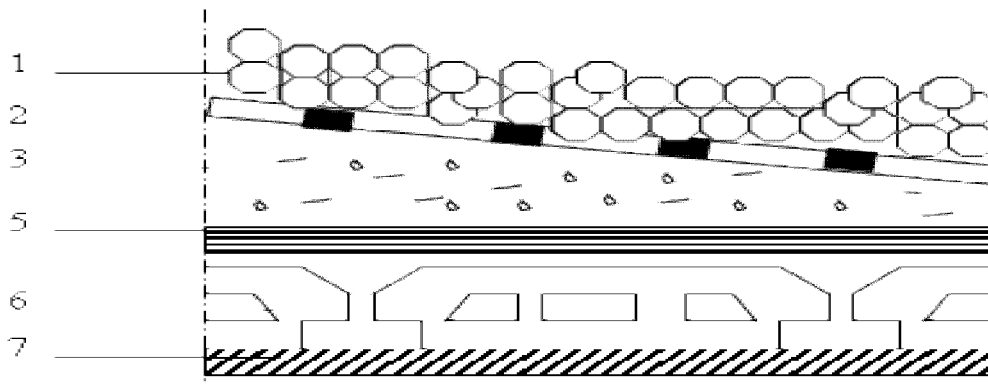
Coupe verticale du plancher terrasse inaccessible
